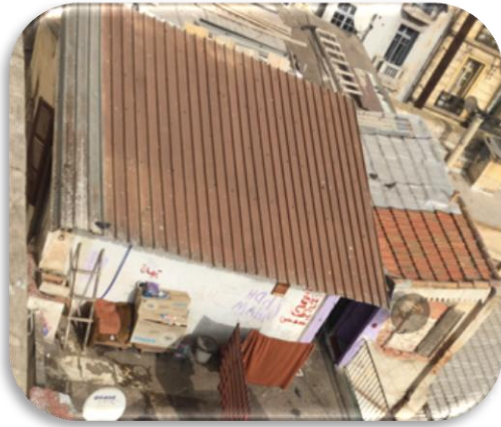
Fenêtre condamnée à cause de transféré la petite débarras a sanitaire
